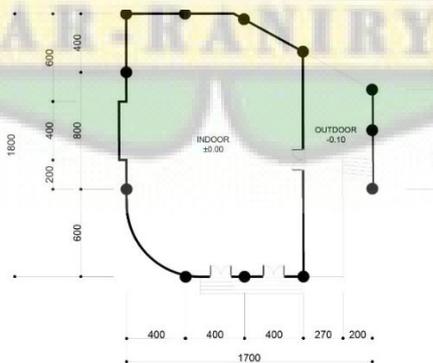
14 Denah Area Pelatihan Kasar Lantai 1
